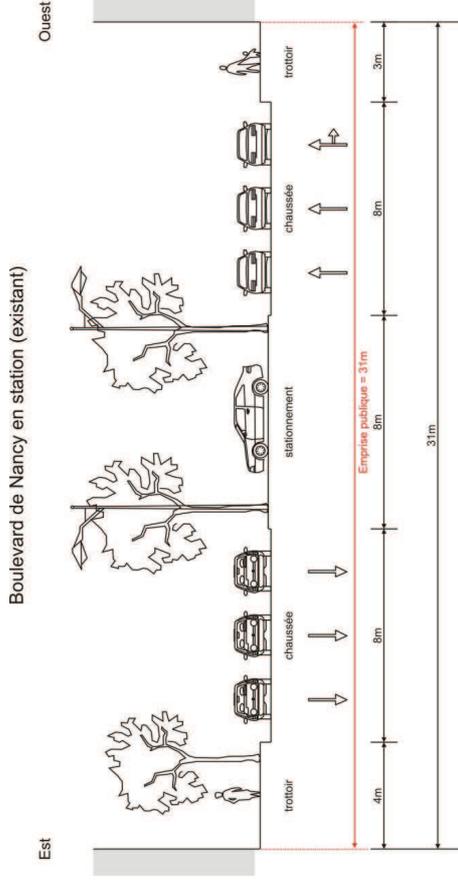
Situation initiale – coupe 31 – sur le boulevard de Nancy au niveau de la station projetée
